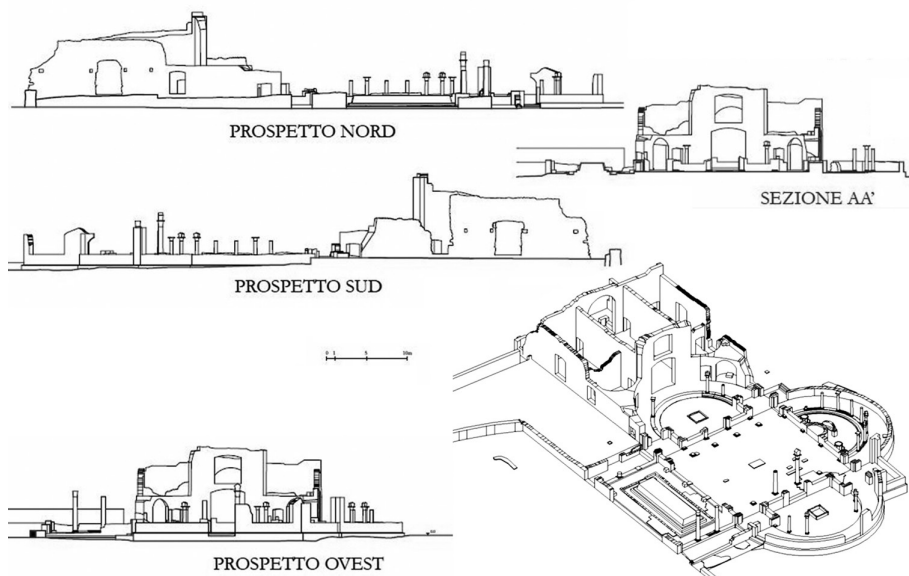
Edificio con Tre Esedre, restituzione grafica dei prospetti, delle sezioni e modello volumetrico redatto precedentemente al restauro.
